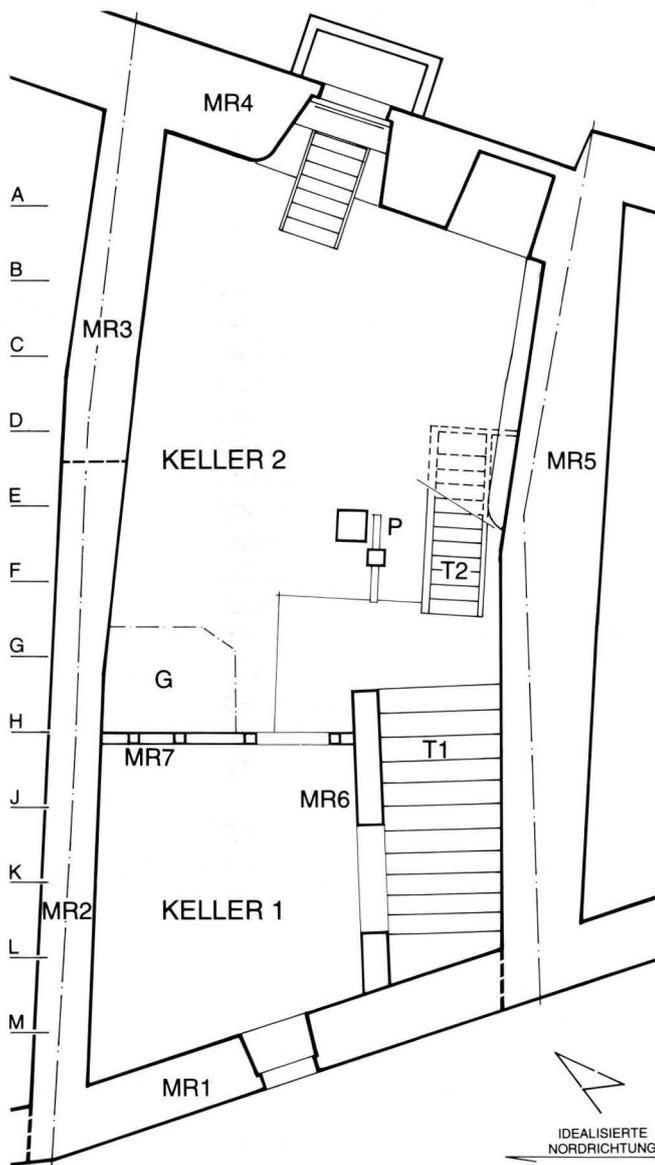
Gerbergasse 81. Übersichtsplan: Grundriss des Untergeschosses vor dem Umbau. Der gewinkelte Nordpfeil zeigt die genaue, der gerade Pfeil die idealisierte Nordrichtung (Text) an. – Zeichnung: C. Glaser. – Massstab 1:200.
